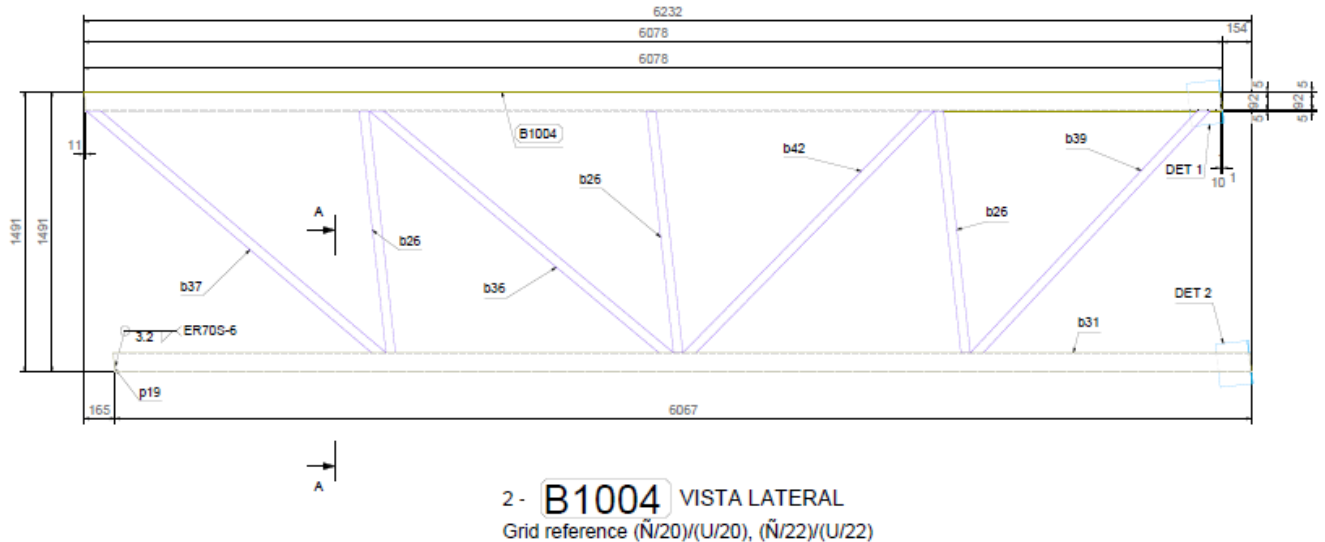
43. Cercha de techo central proyecto ANDE. Fuente: Planos de taller en Advanced Steel de Grupo Yeril S.A.
